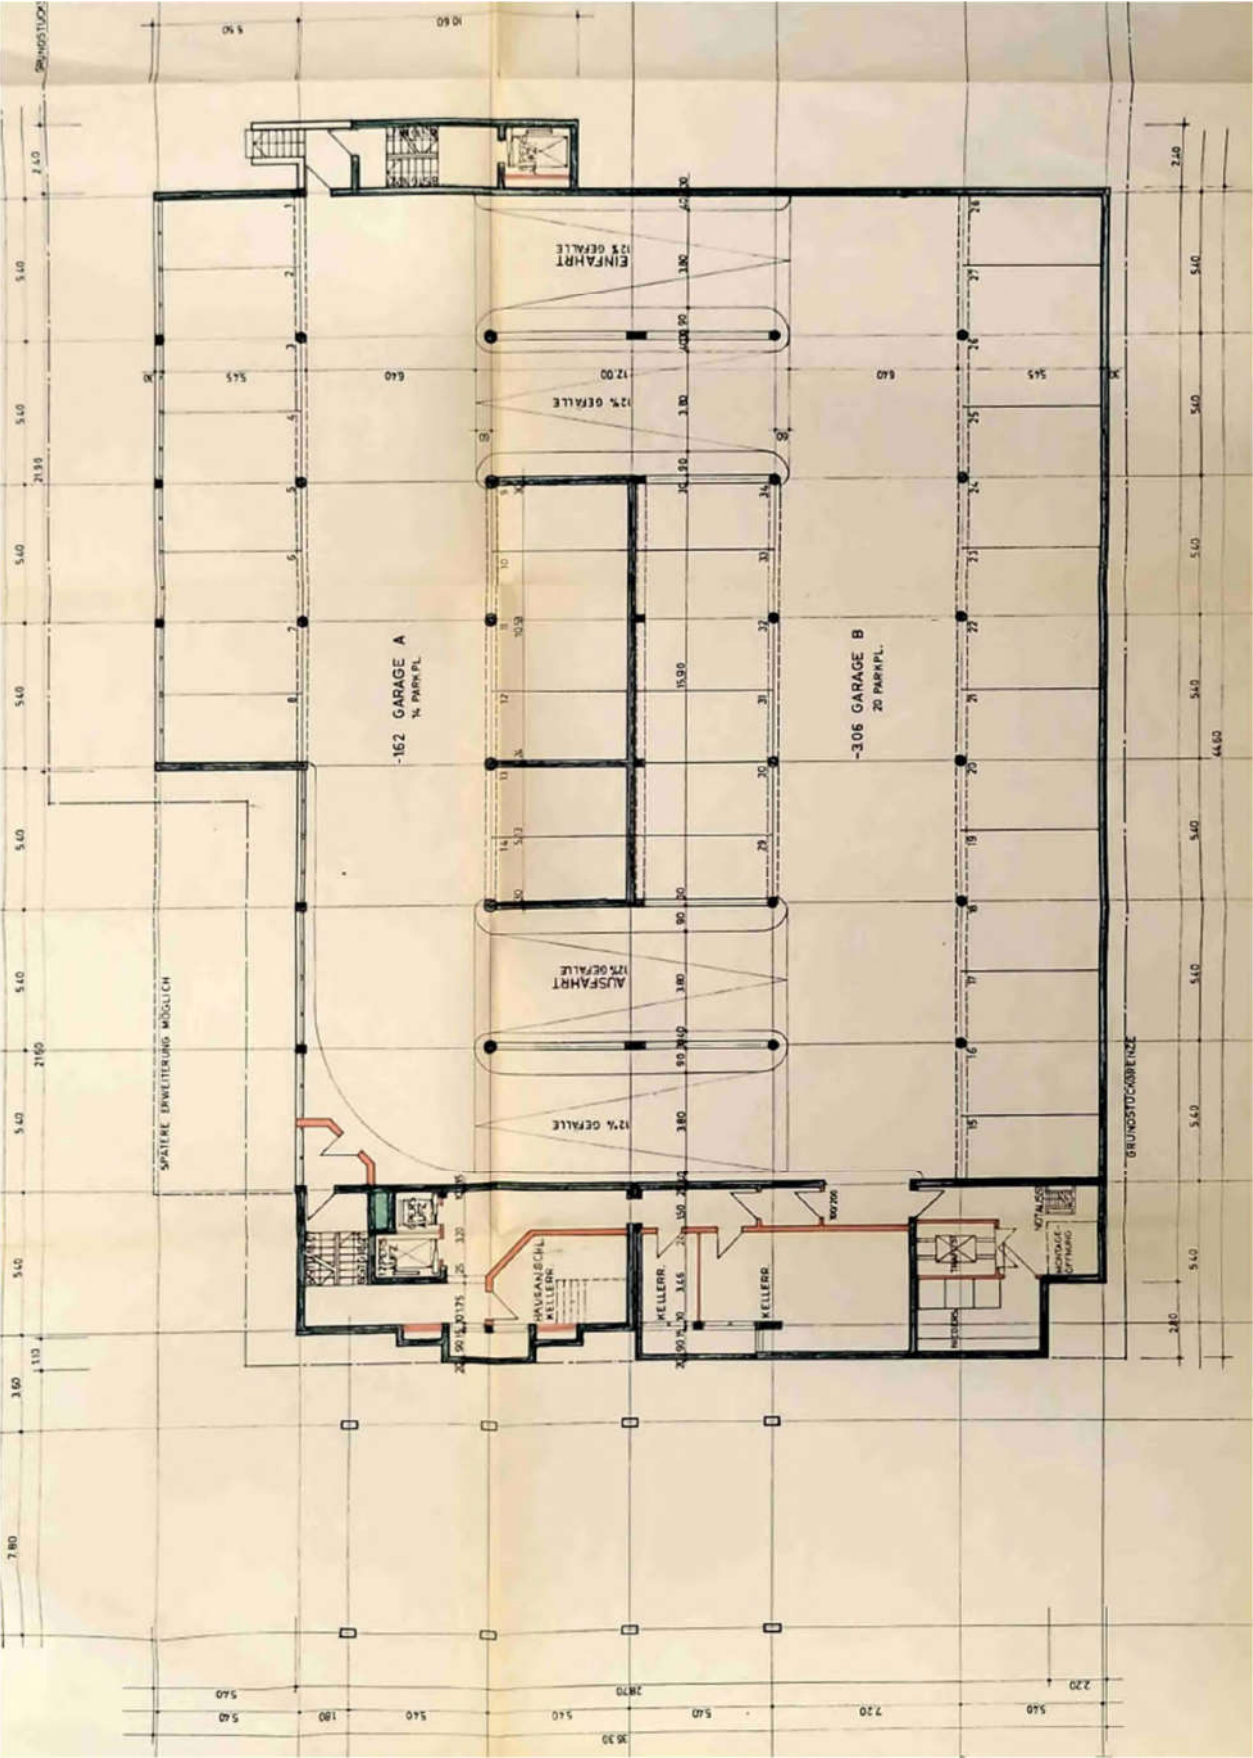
Grundriss 1. Garagengeschoss
